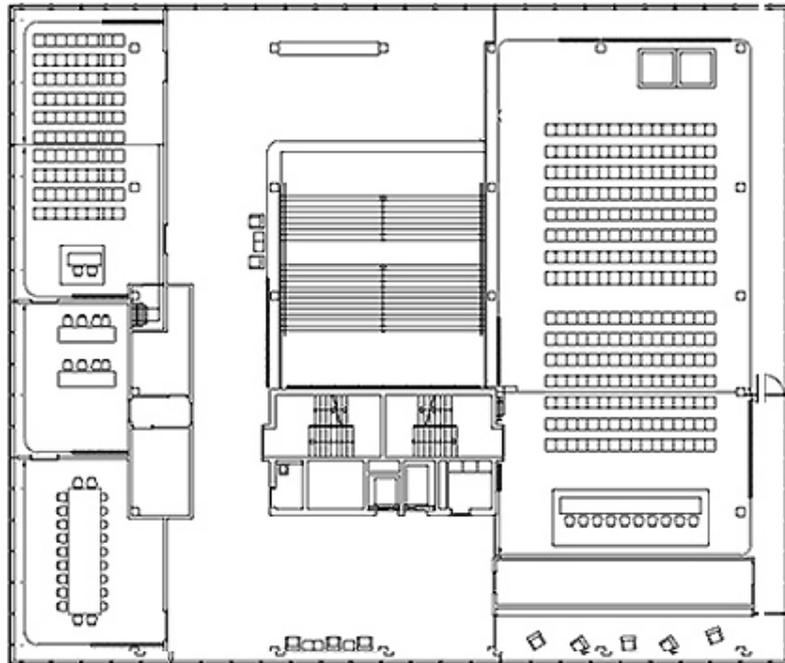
Heinrich-Böll-Stiftung Grundriss 1. OG
